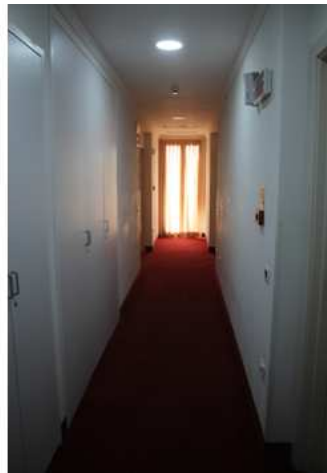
1.60: corridoi distributivi piano rialzato: lato sud e lato nord
